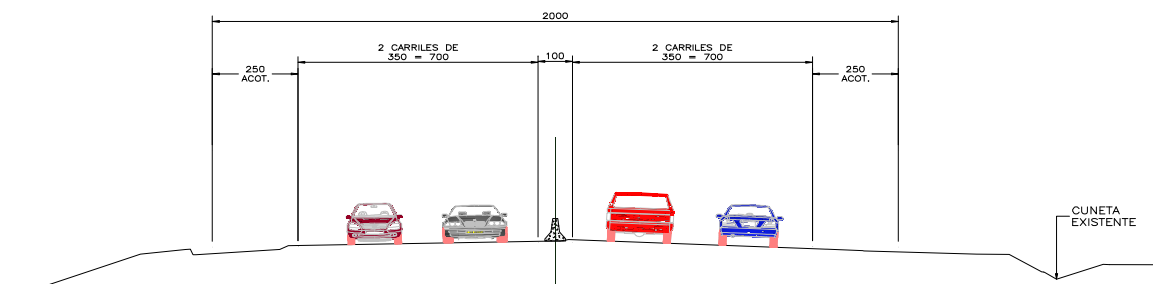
Sección transversal de la autopista. (Fuente: plano de planta general de proyecto)
